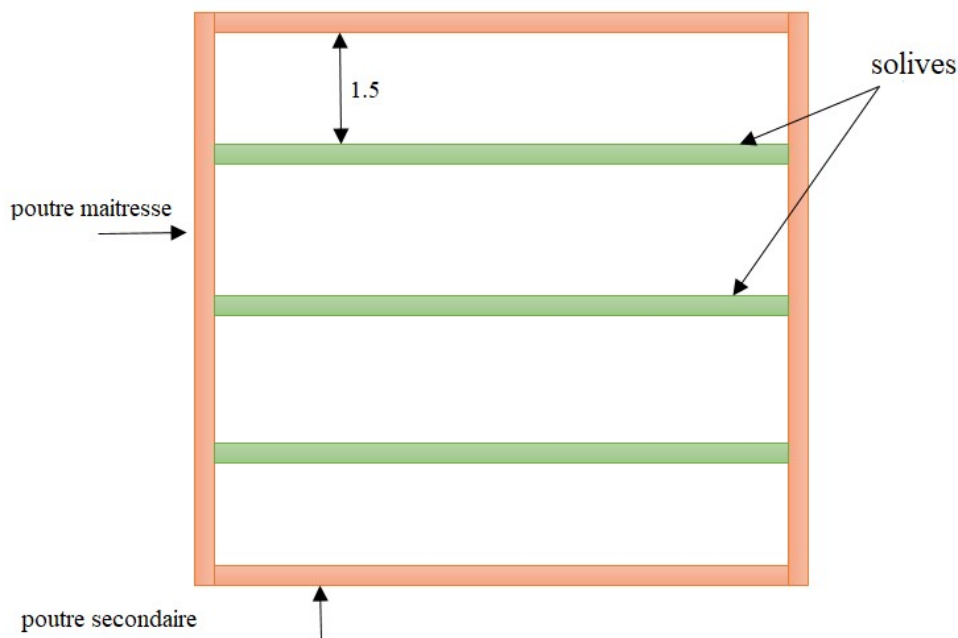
Disposition des solives sur la poutre maitresse.
